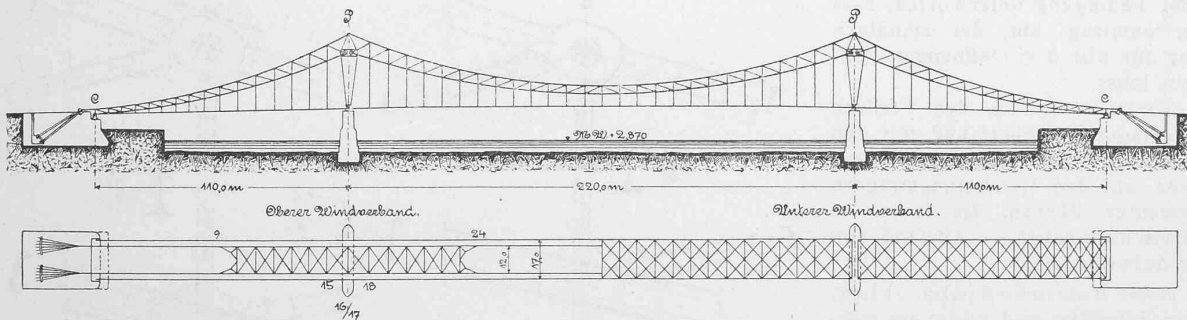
Schematische Darstellung der Hauptträger. — Aufriss und Grundriss. — Masstab 1 : 3000.
